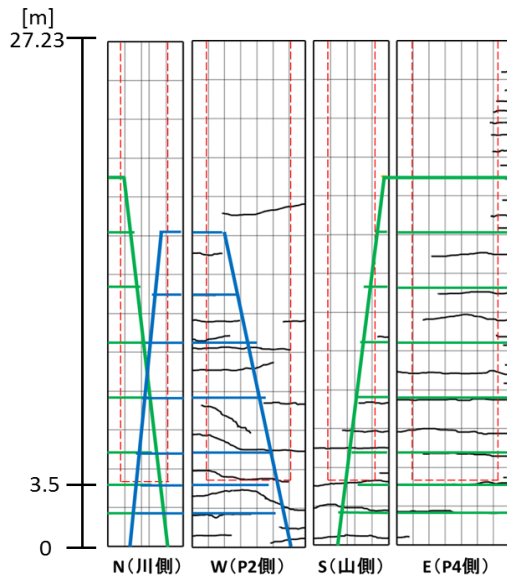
P3橋脚ひび割れ再現図(2方向)
